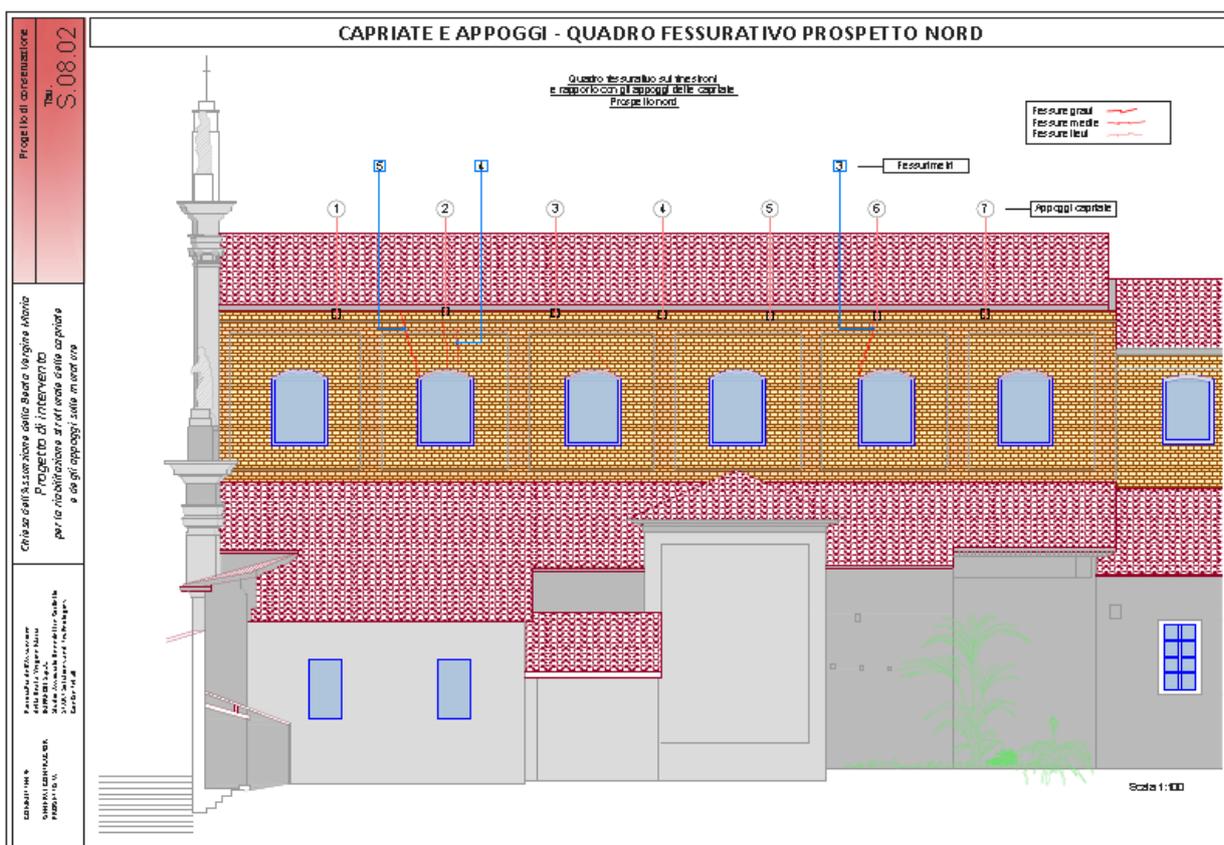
Prospetto nord con indicazione della posizione delle 7 capriate lignee e dei fessurimetri.
